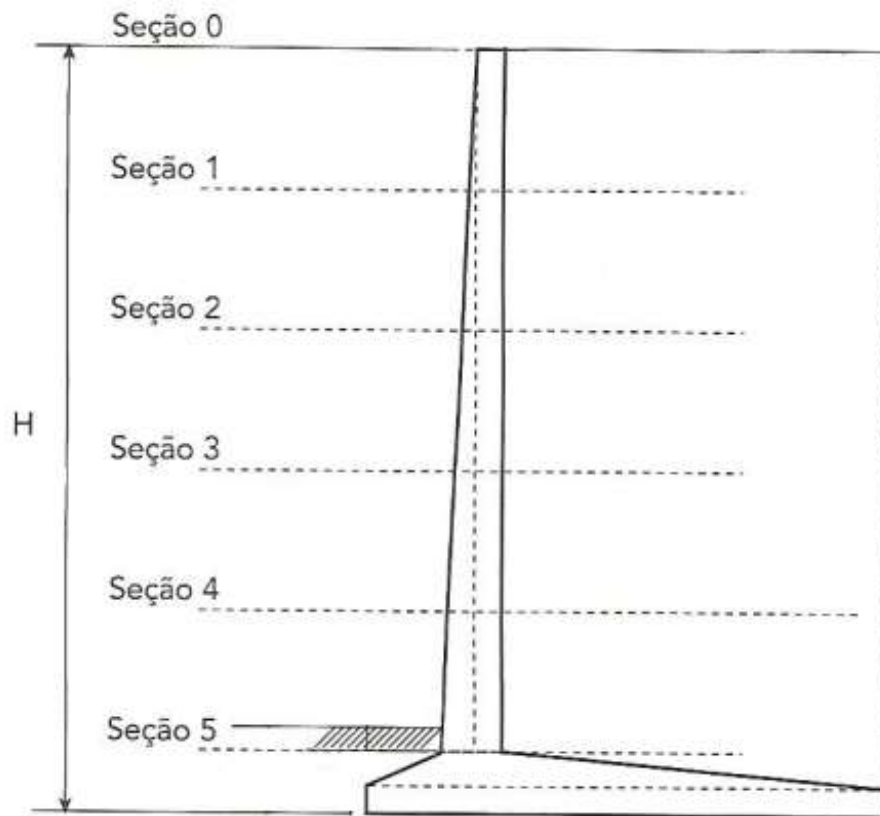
Divisão do muro de flexão em seções. Fonte: próprio autor, adaptado de MARCHETTI (2007).
